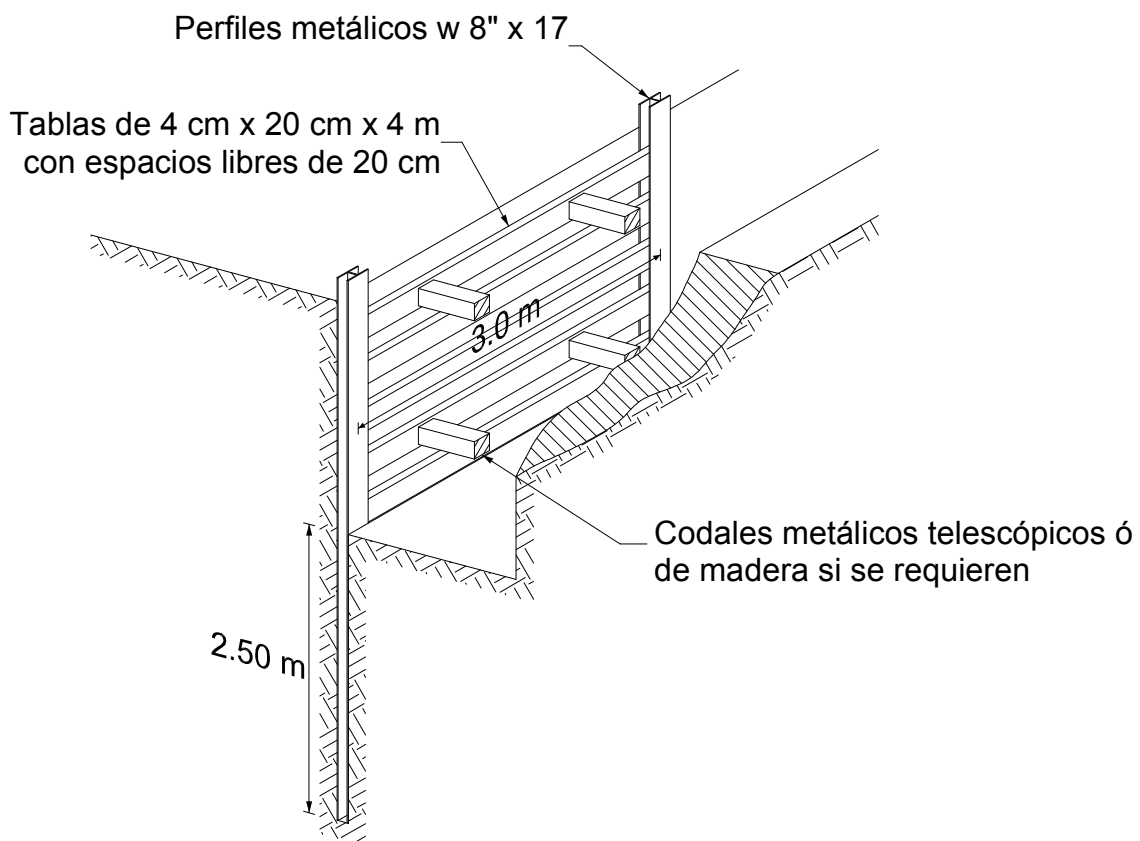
Esquema típico de Entibado Tipo 1A alternativo.
